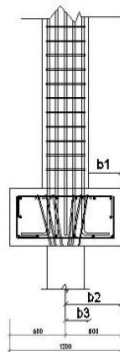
Gaya yang bekerja pada Pile Cap
